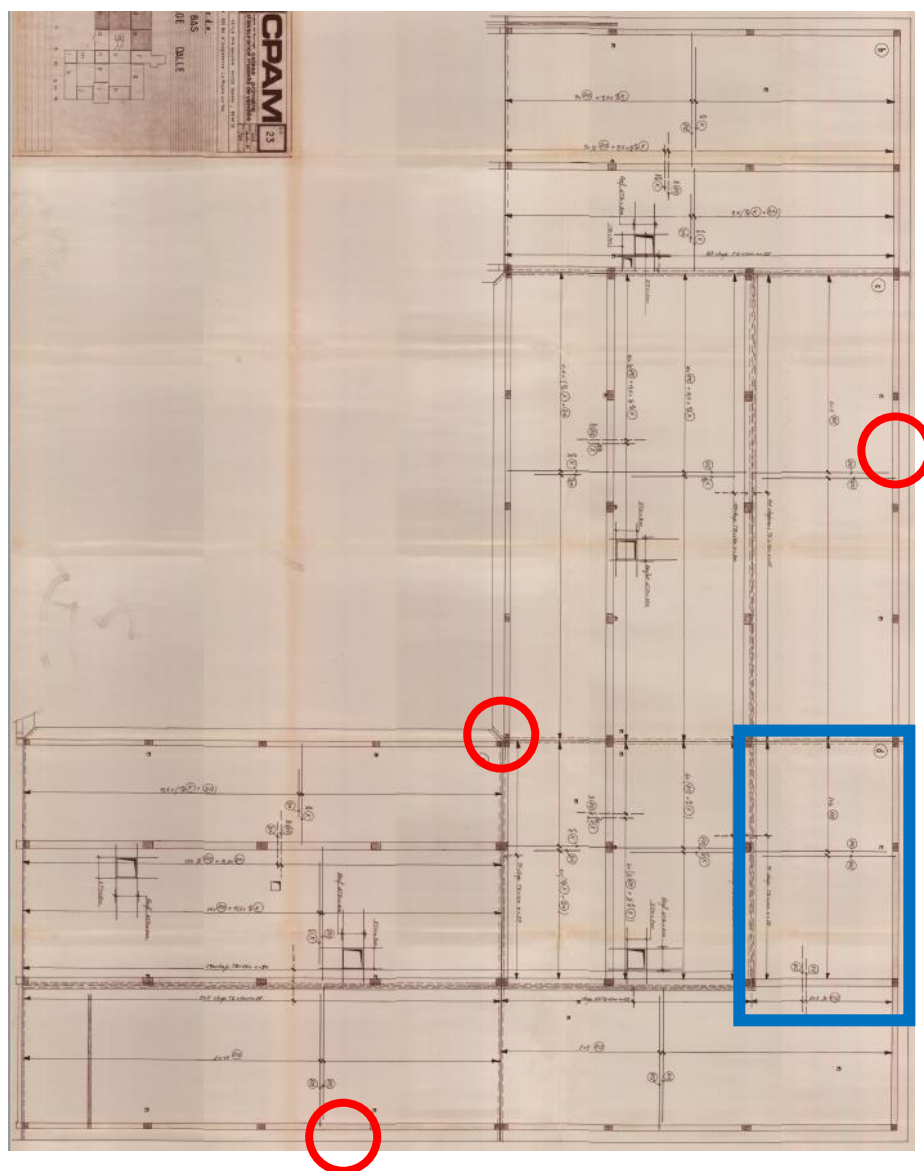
Extrait plans ferrailage plancher haut RDC bas
